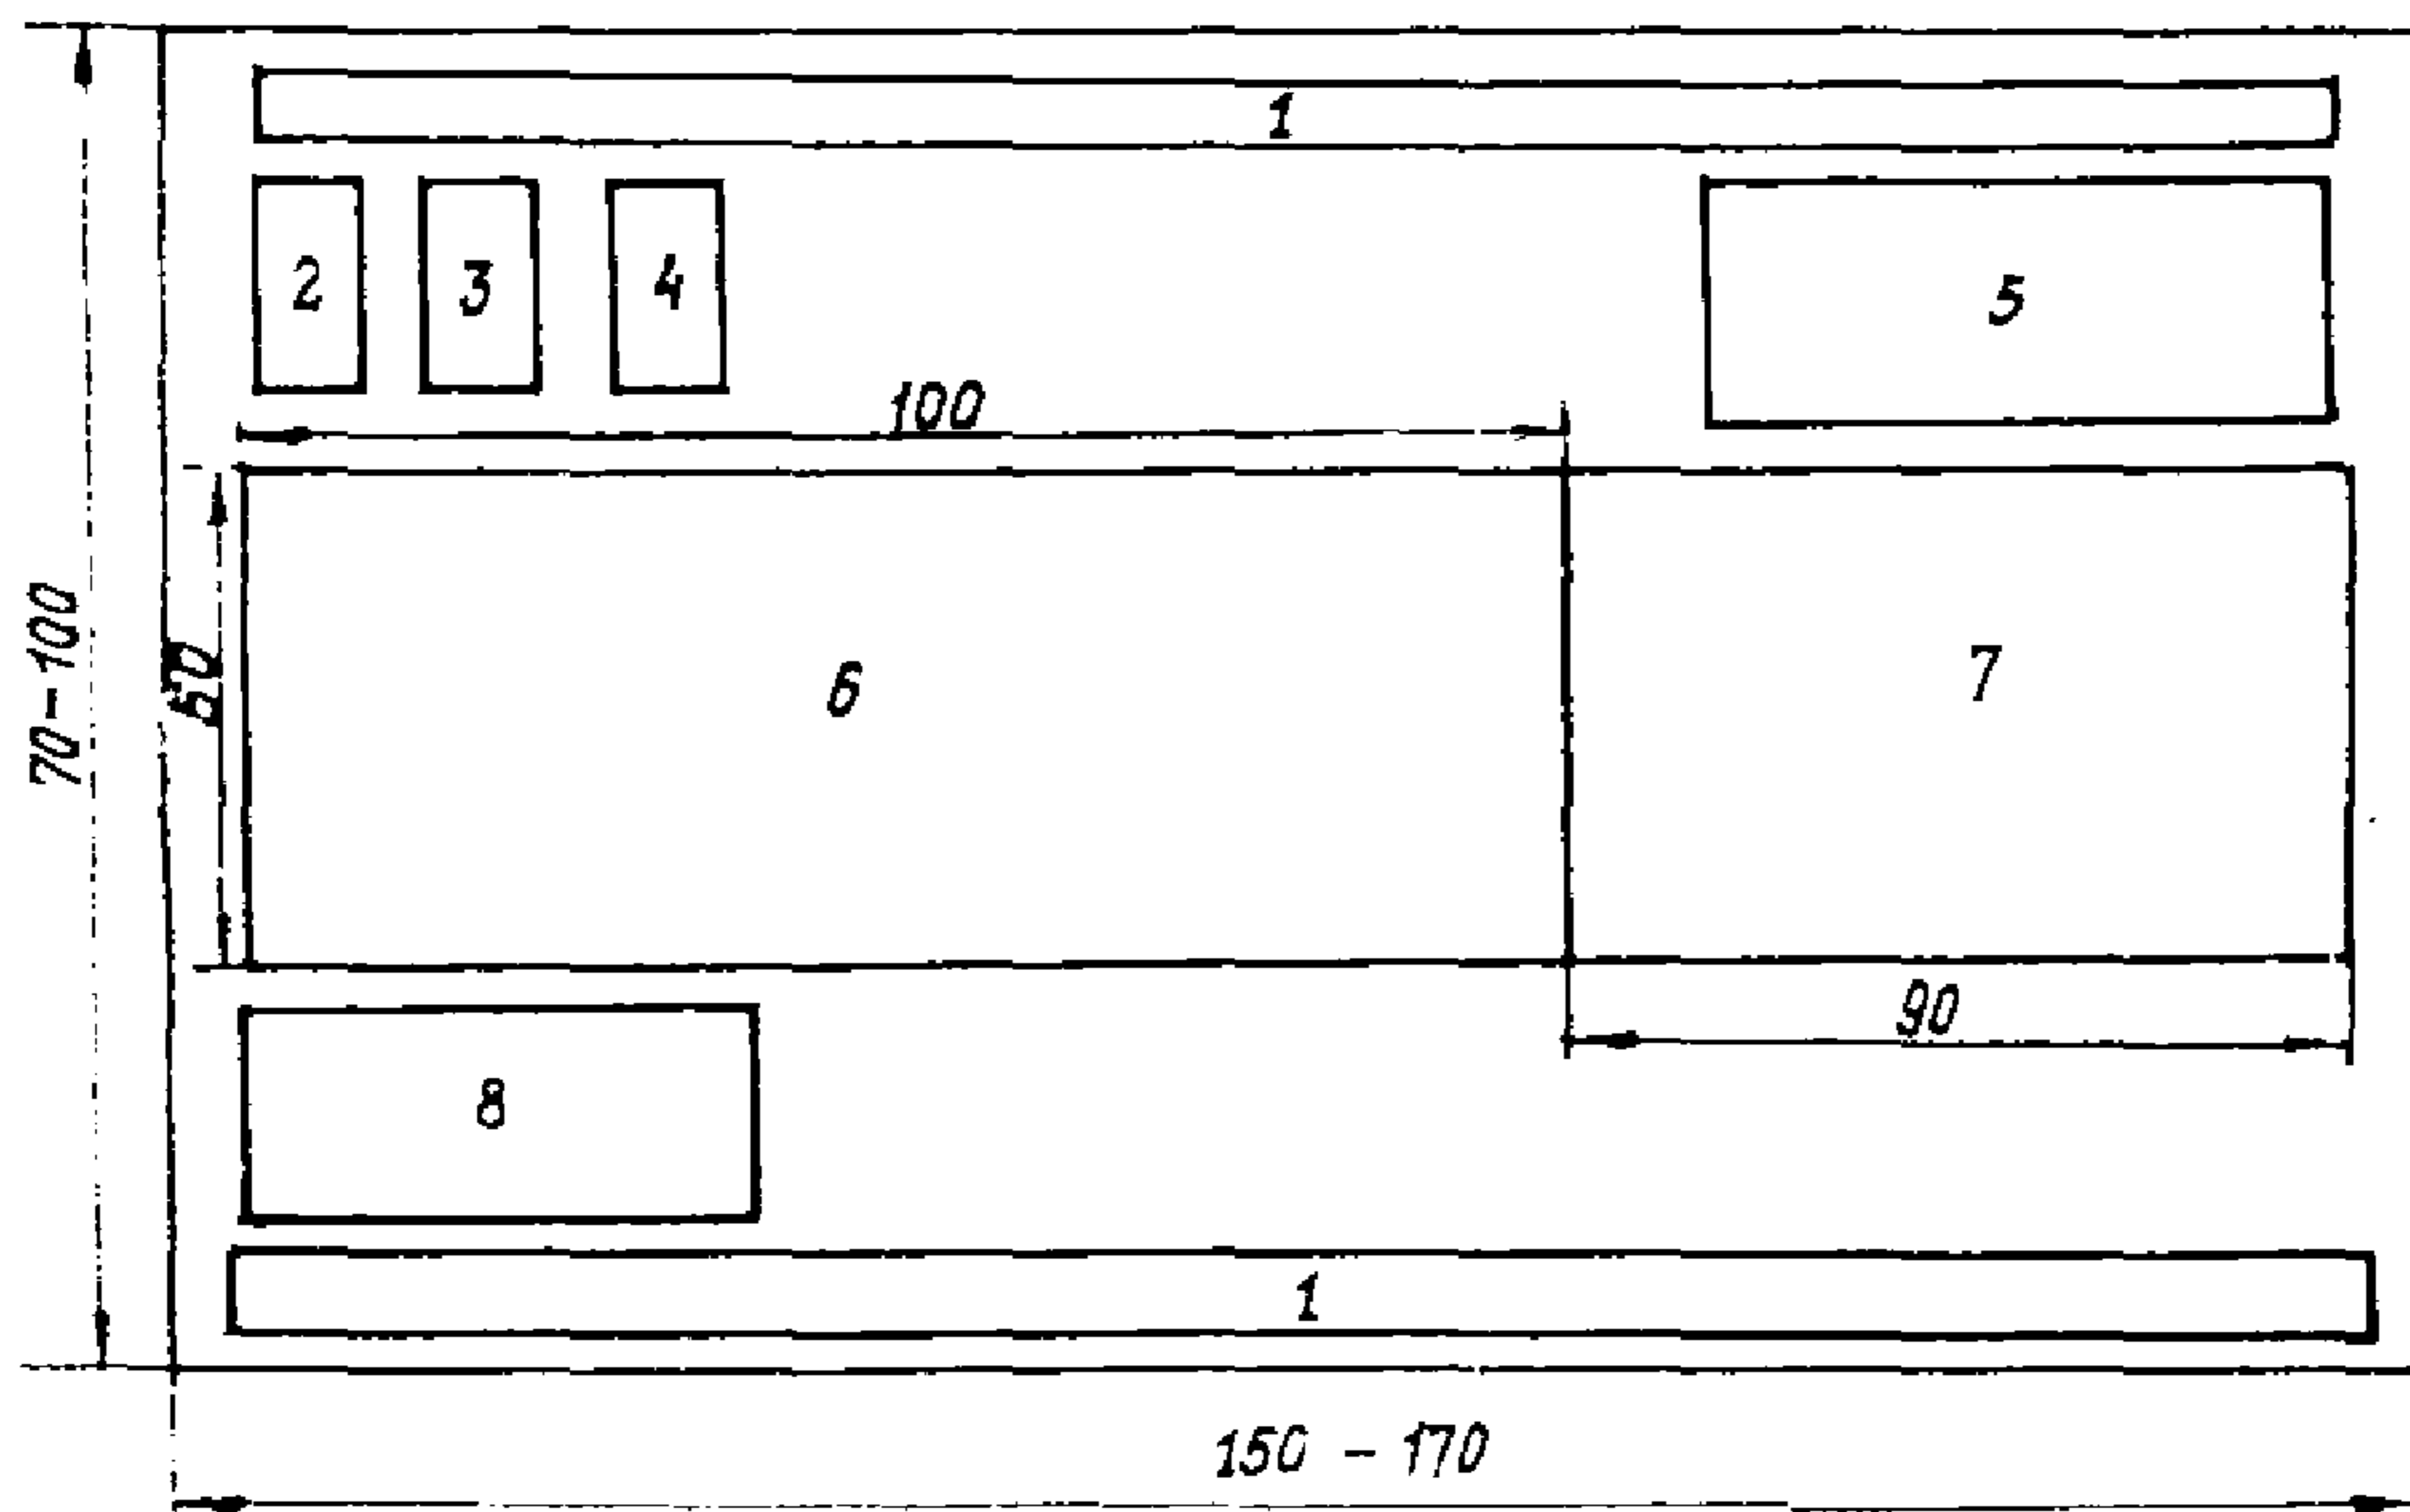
Типовой генплан сварочной базы БТС-143
